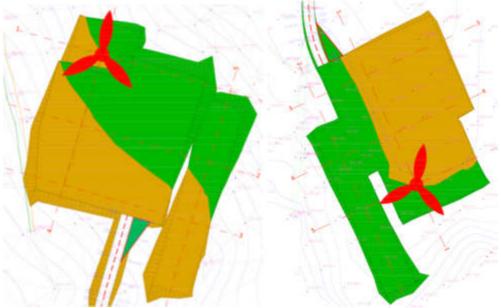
A destra la Planimetria BCN01, a sinistra la planimetria BCN04
